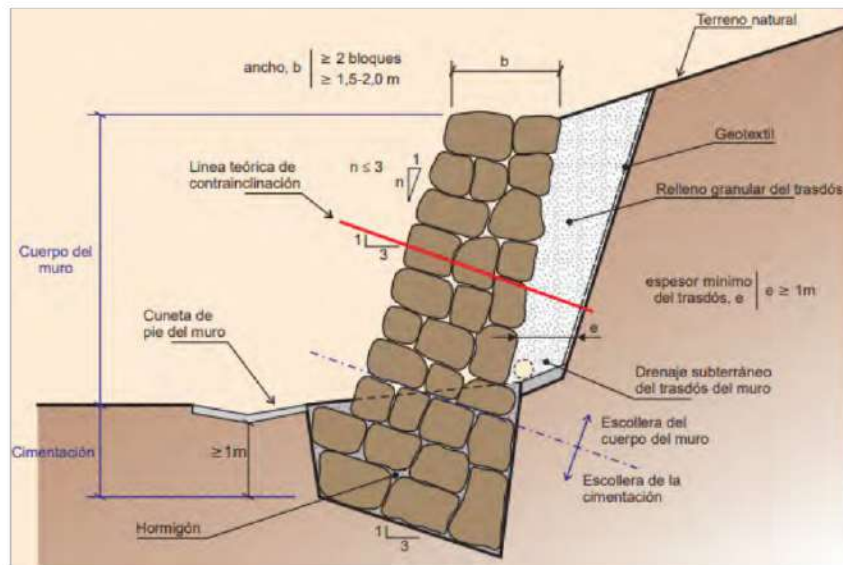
Perfil constructivo de muro de escollera colocada. Fuente y elaboración: Ministerio de fomento de España, 2006.
